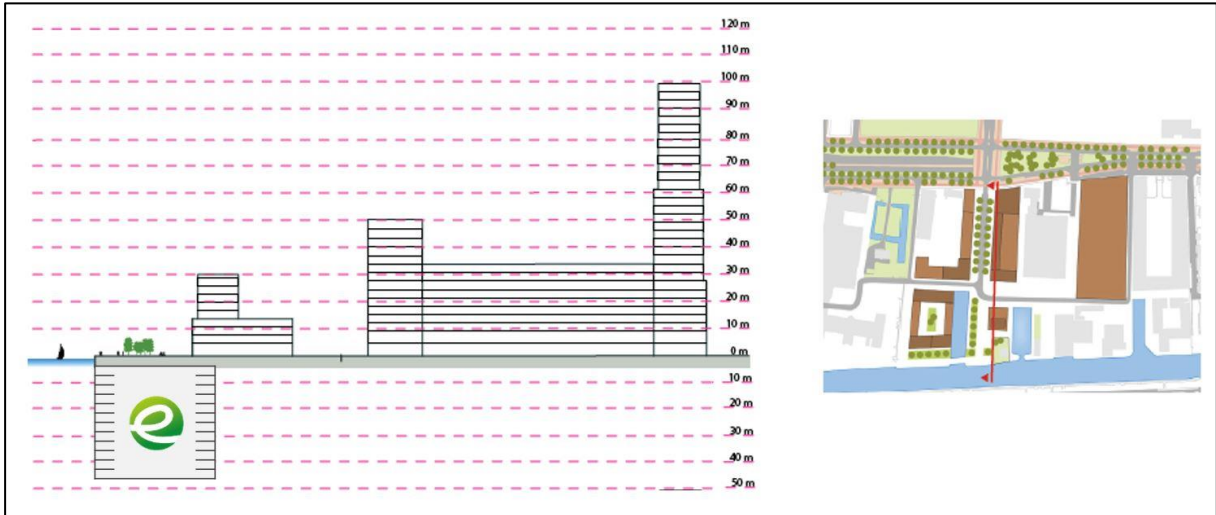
Referentiebeeld voor de ontwikkeling van de Trekvliztzone uit het Stedenbouwkundig Plan.
